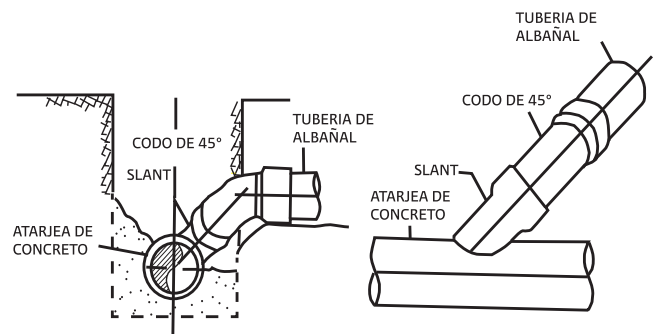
A DESCARGA RECOMENDADA CON TUBERÍA DE CONCRETO
